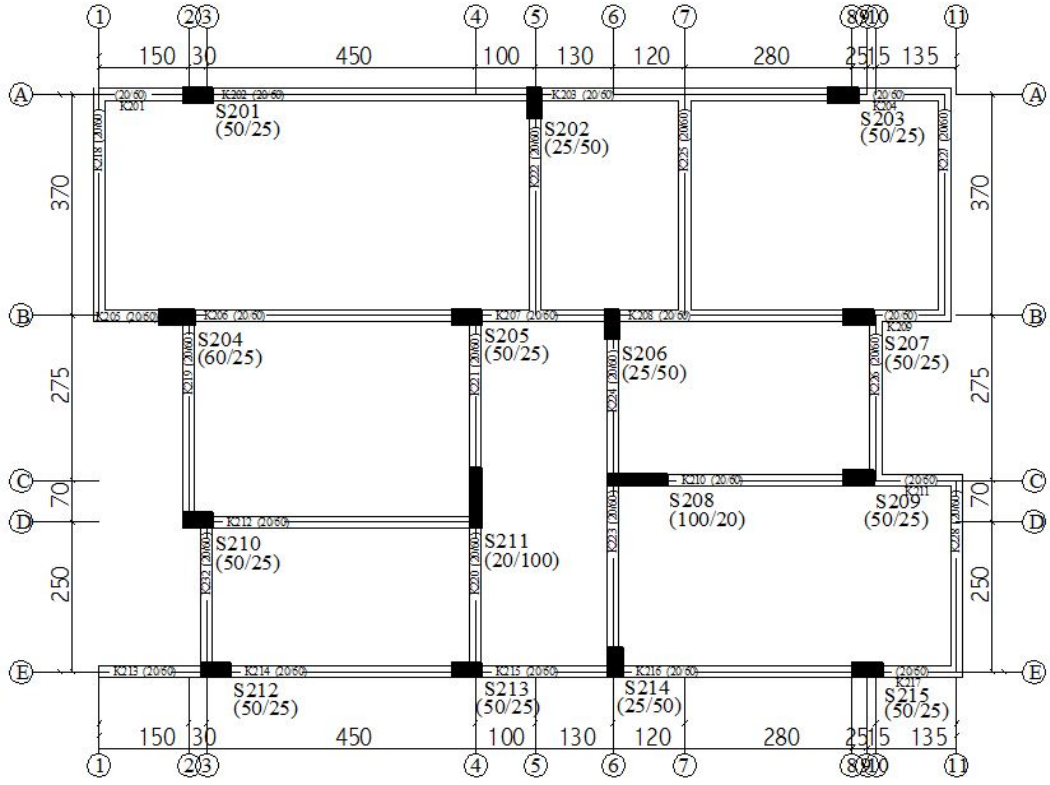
3K-B1 nolu binanın kalıp planı
